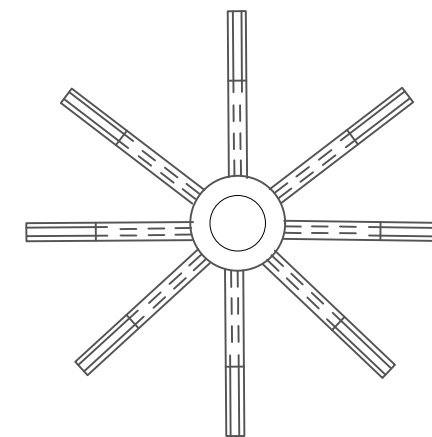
DETAIL STŘEŠNÍ KONSTRUKCE M 1:10
